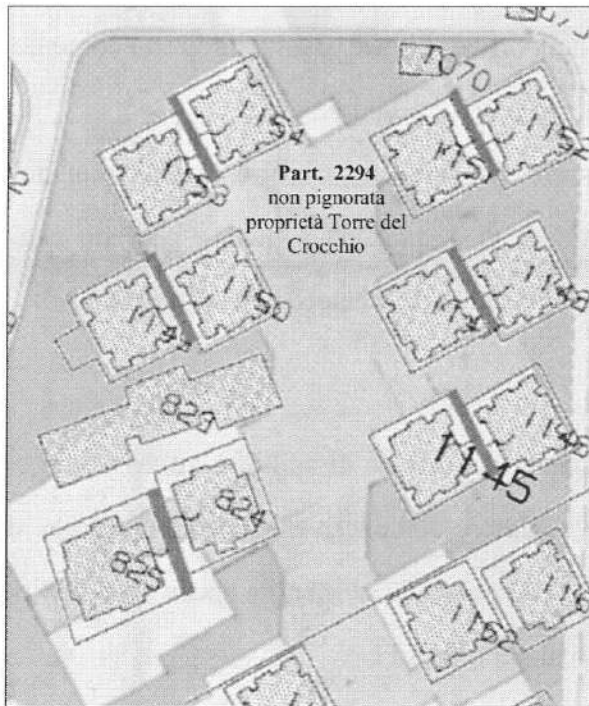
e 48 sovrapposizioni tra planimetria di progetto, planimetria catastale e tipo mappale.
